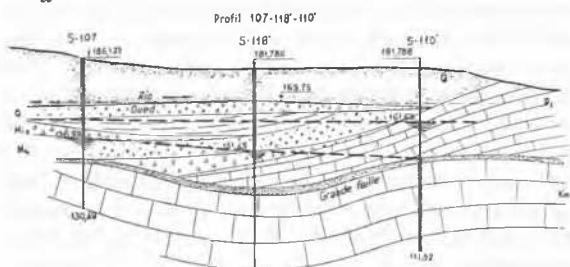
Coupe à gauche de la faille – sondages 107, 118 et 110
